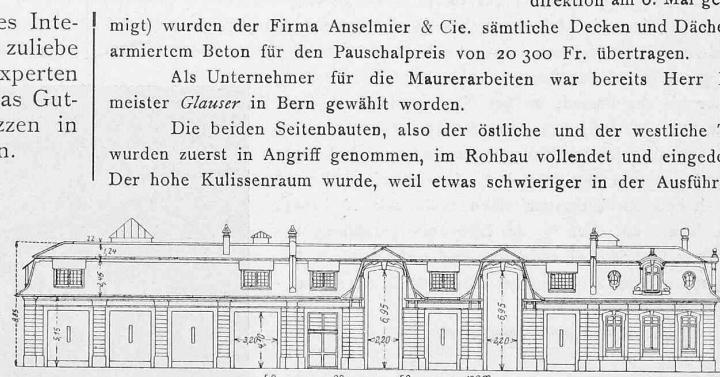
Ansicht des Theaterdekoration-Gebäudes an der Nägeligasse.
